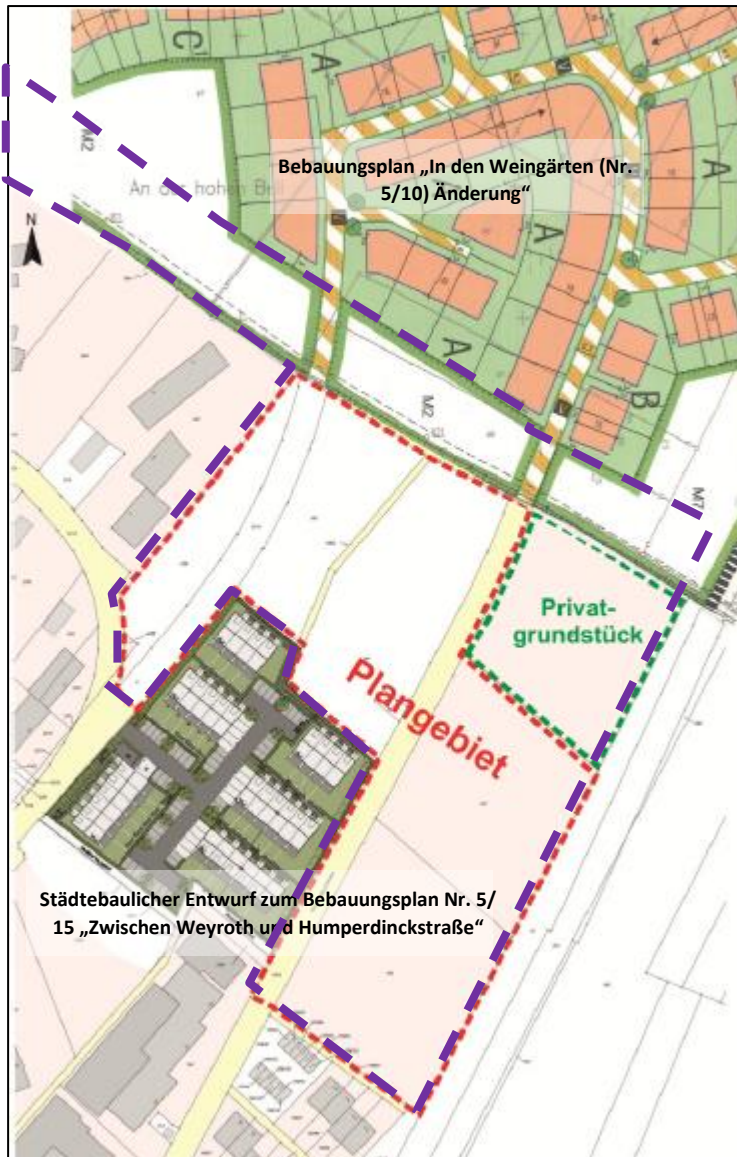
Lage der angrenzenden Bebauungspläne (lila Markierung: aktuelle Abgrenzung des Geltungsbereichs)
